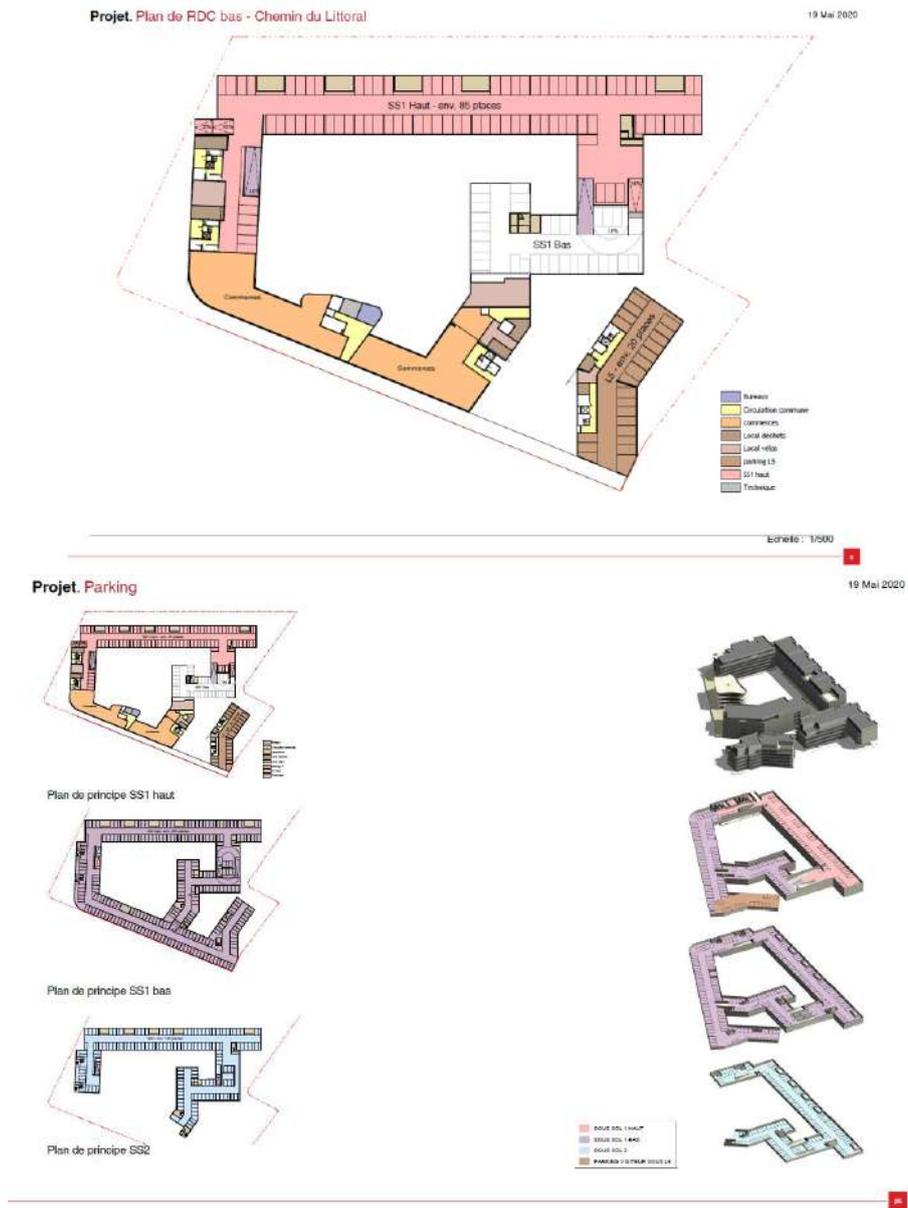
Plan du RDC et parking du projet d'aménagement (source : Kaufman & Broad)
